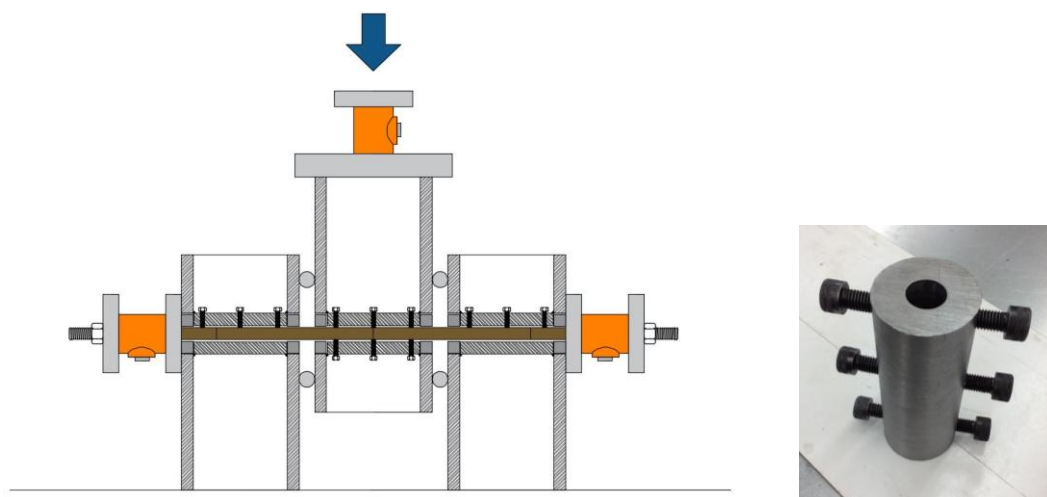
Corte esquemático do *setup* de ensaio de corte-flexão e pormenor dos cilindros metálicos que foram soldados no interior dos blocos
